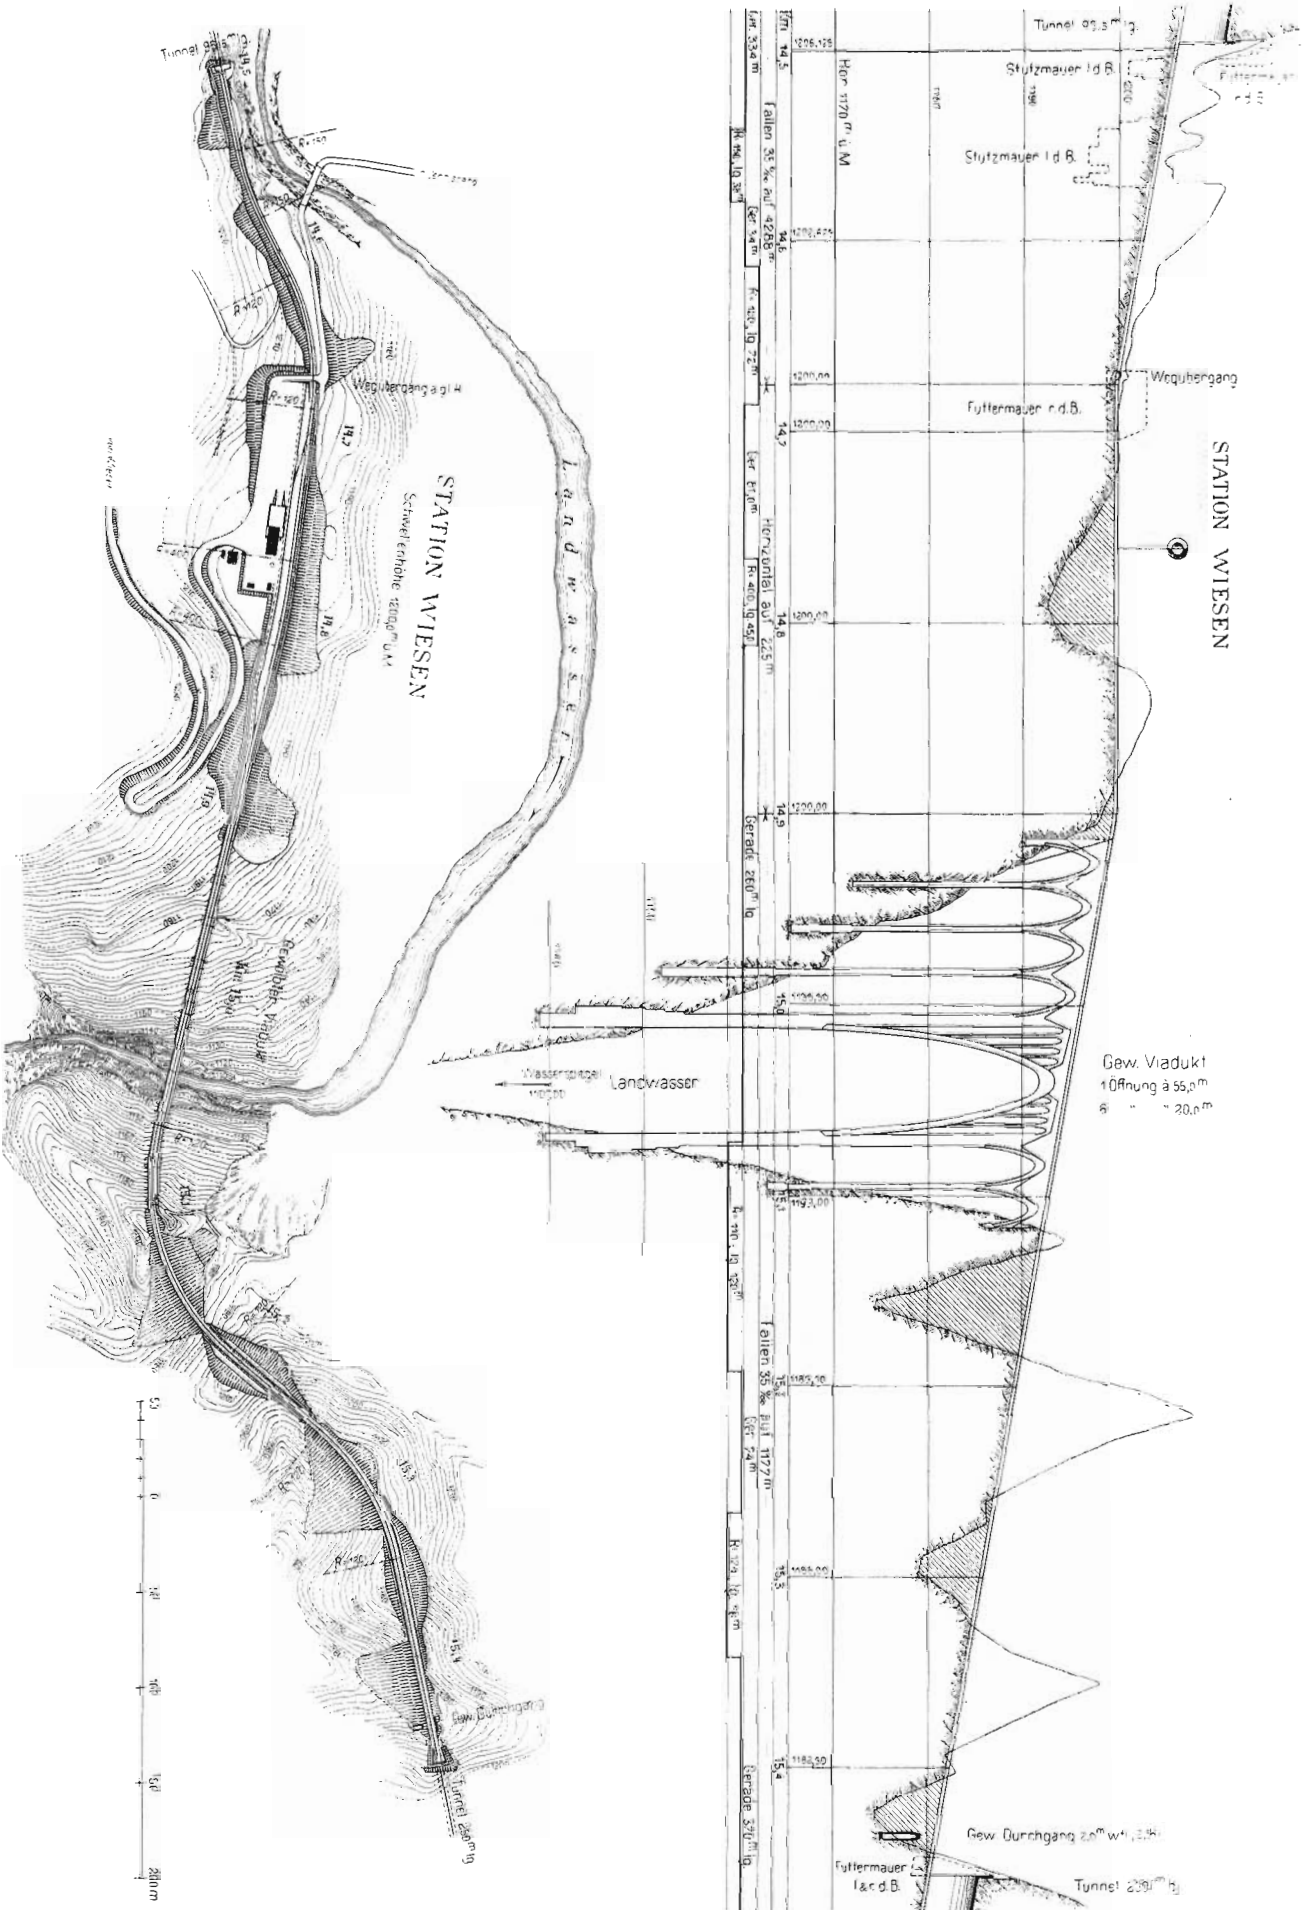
Lageplan und Längsprofil der Station Wieschen und des Wiesener Viadukts. — Massstab für Lageplan und Längen 1 : 4000, für die Höhen 1 : 800.
